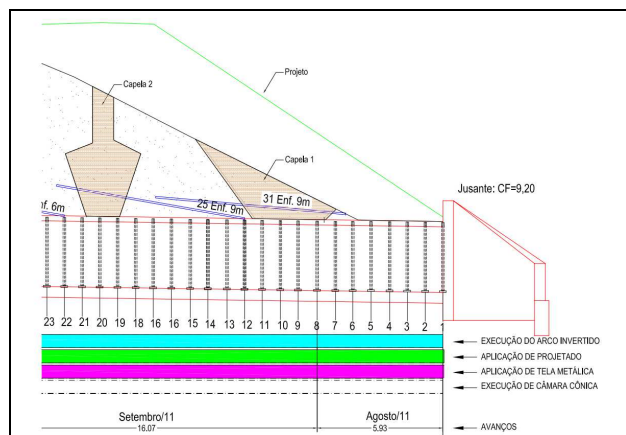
Perfil da capela formada a jusante da escavação do túnel, “As Built” – Túnel Sob a BR-101 Parnamirim RN, 2011.
